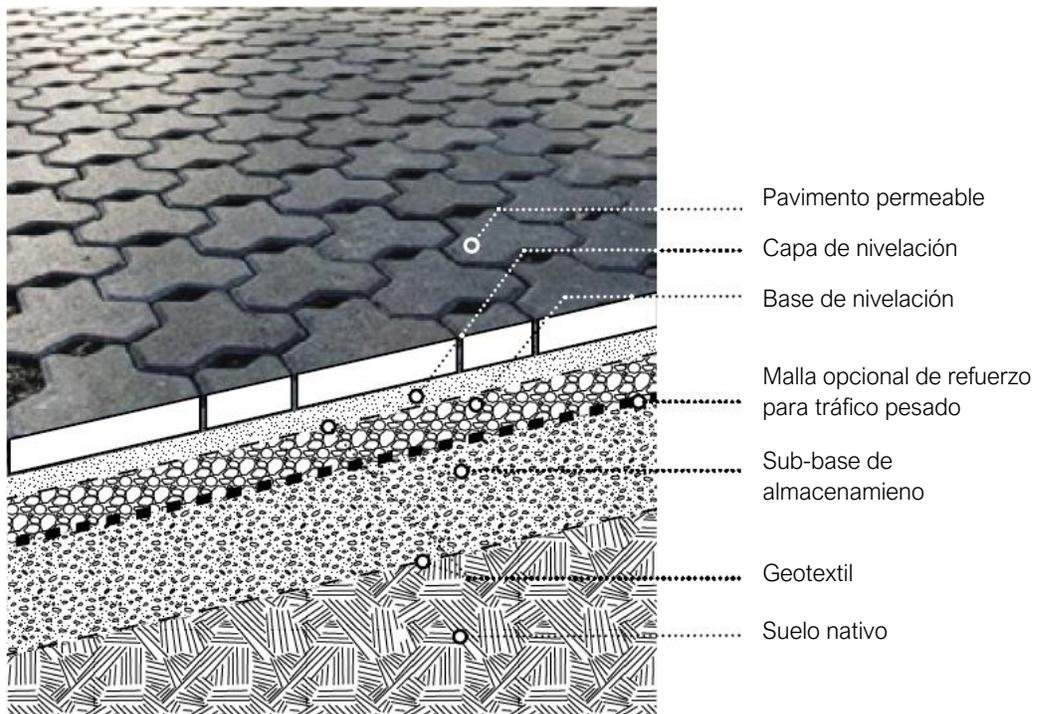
Pavimentos Permeables - Especificaciones Técnicas
